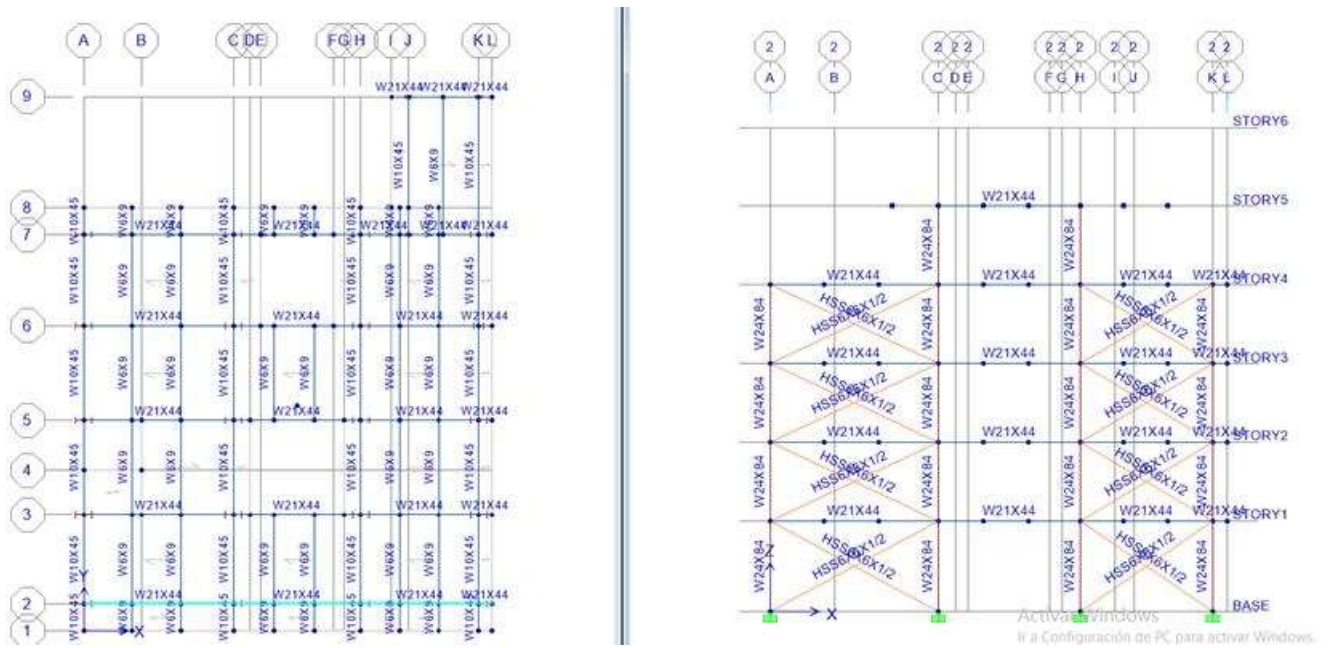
Esqueleto Estructural para el proyecto ETABS – Elementos estructurales predimensionados
